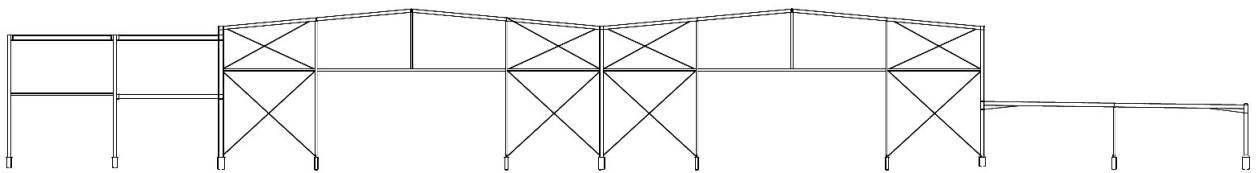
Esquema del pórtico de fachada de la estructura proyectada
